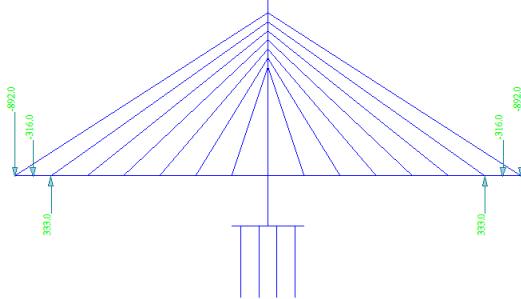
42 Permodelan saat Construction Stage 1 (CS 1)
